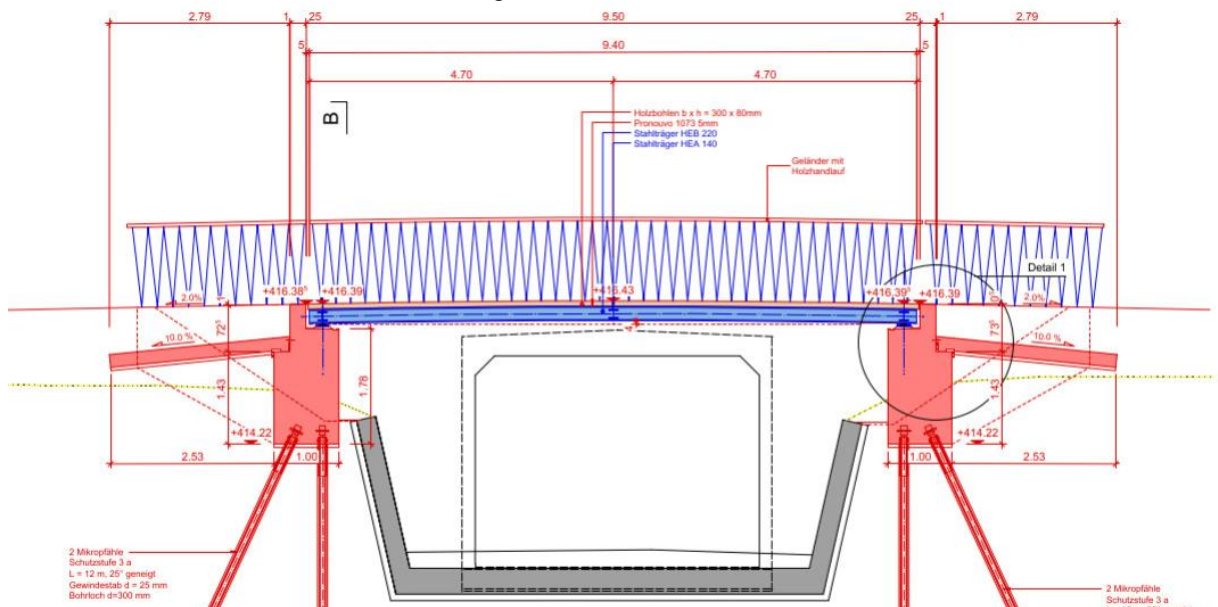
Längsschnitt Radwegbrücke Brüggli West, Stand Bauprojekt (August 2024)
